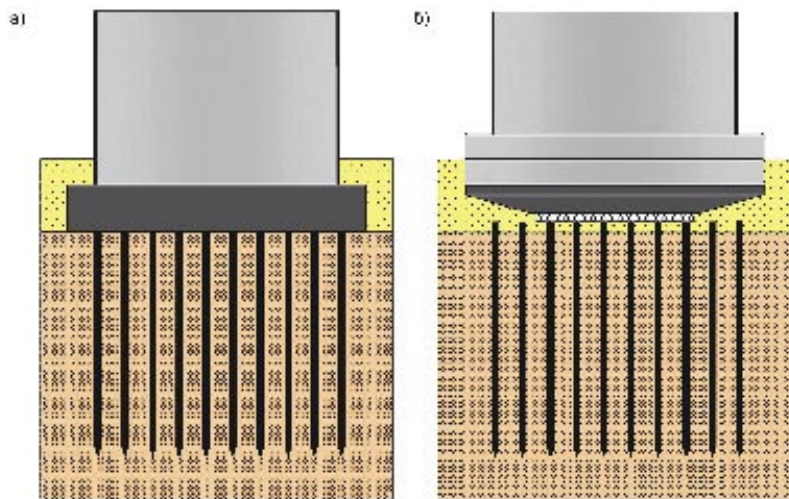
Свайно-плитные фундаменты: а – свайно-плитный фундамент, б – несвязный свайно-плитный фундамент
